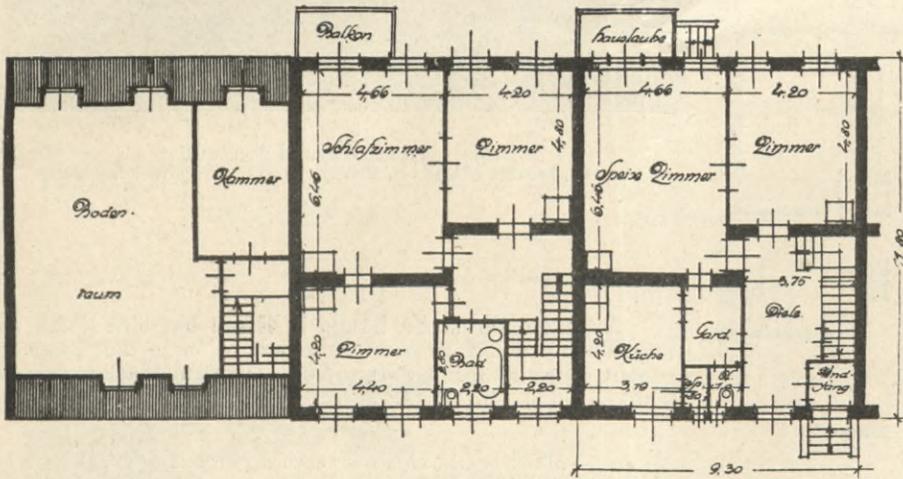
Reihenhäuser der Beamten-Baugenossenschaft zu Worms. Architekt Neiß
